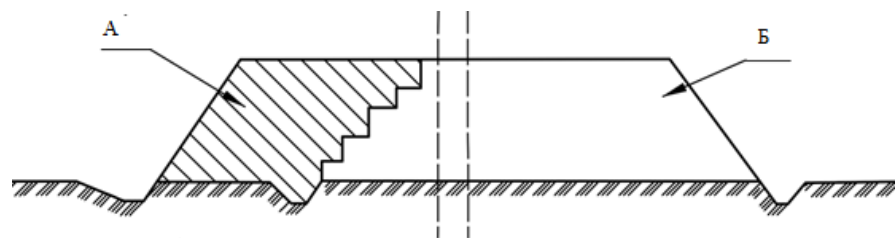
Схема уширения земляного полотна на 21-м км автомобильной дороги: а — свежеложенный грунт; б — существующий грунт
